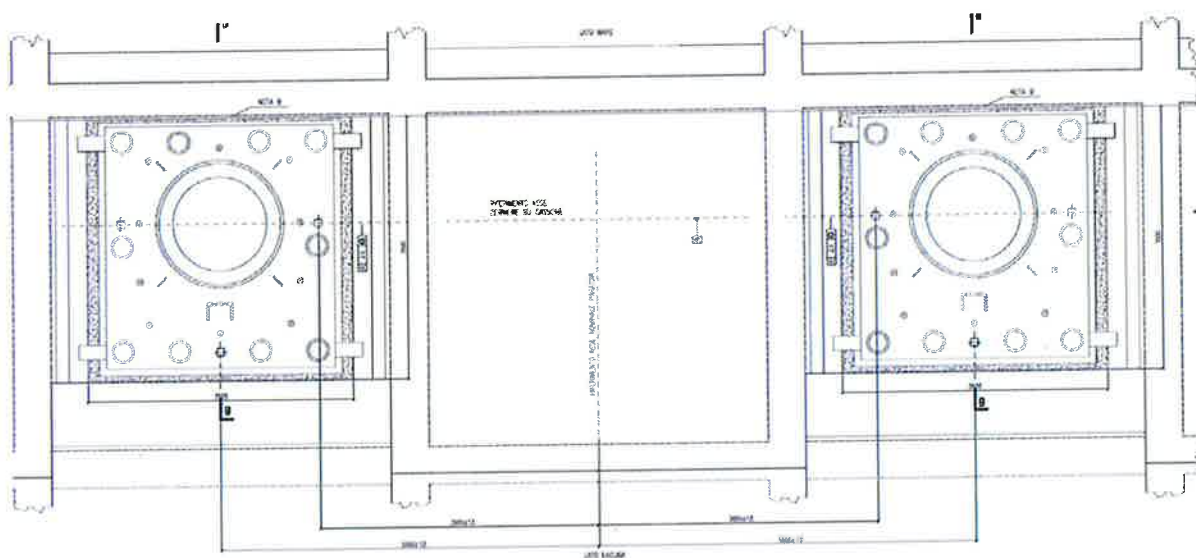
ELEMENTO FEMMINA – TOLLERANZE DI INGHISAGGIO PLANIMETRICHE
